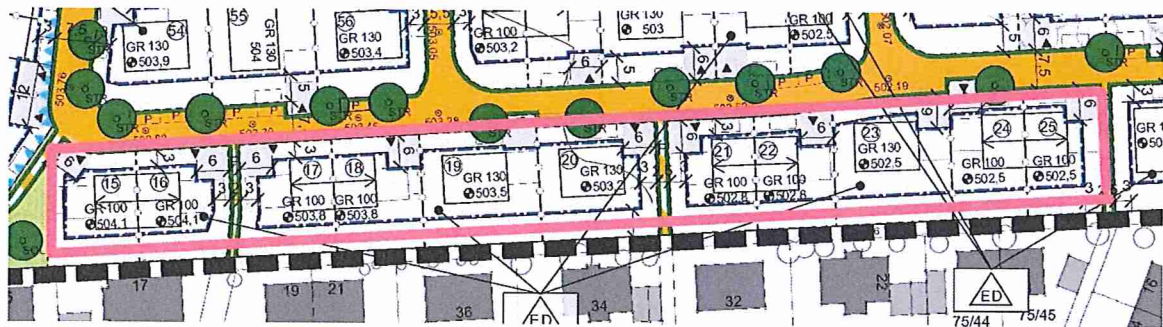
, Ausschnitt, Planzeichnung, Bebauungsplan „Am Schlehbach“, Quelle: PV
